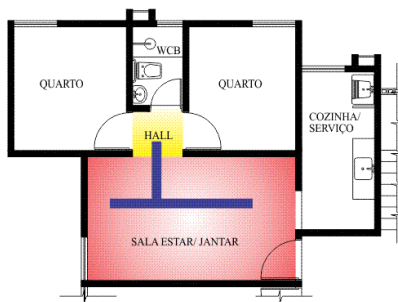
Planta Baixa Pav. Tipo do Residencial Praias Belas (sem escala)
